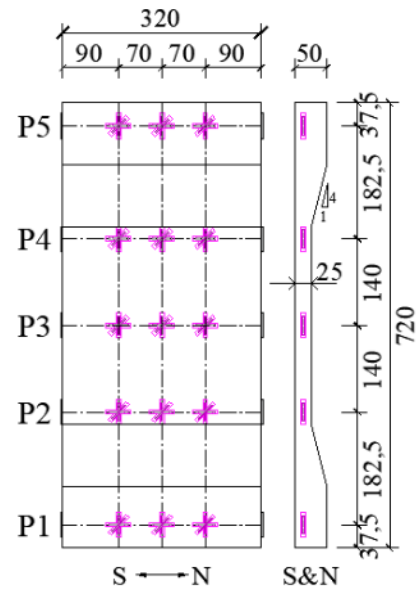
ひずみゲージ取り付け位置 (単位 : mm)
